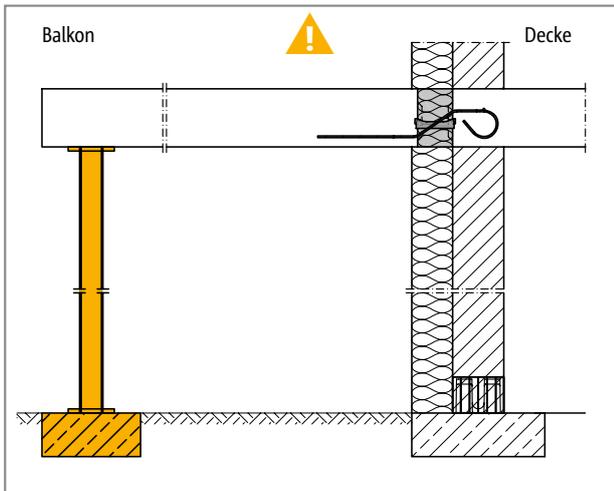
Schöck Isokorb® Typ QXT: Stützung durchgängig erforderlich
